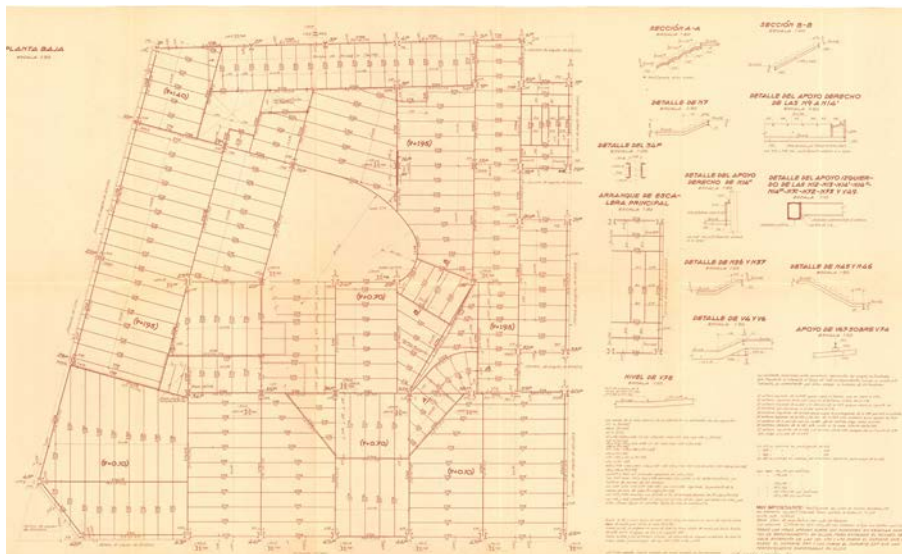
Estructura de la planta baja de la Casa de Suecia (02-05-1954). Archivo Torroja. (CEDEX-Cehopu). ETM-377/Caja 122/01-17.
